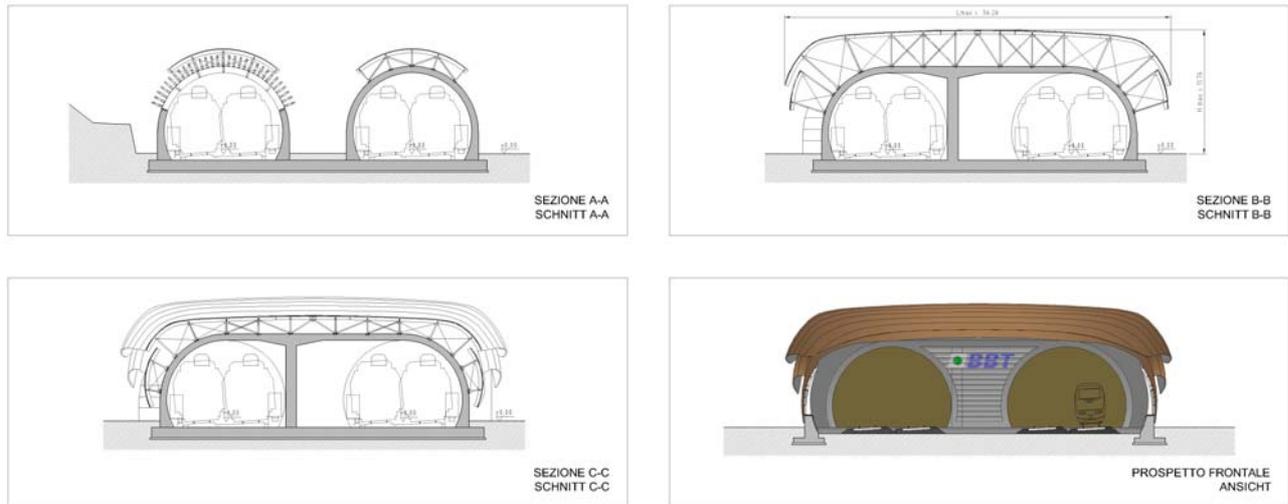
Darstellung im Lageplan – Regelquerschnitte des Tunnelportals
